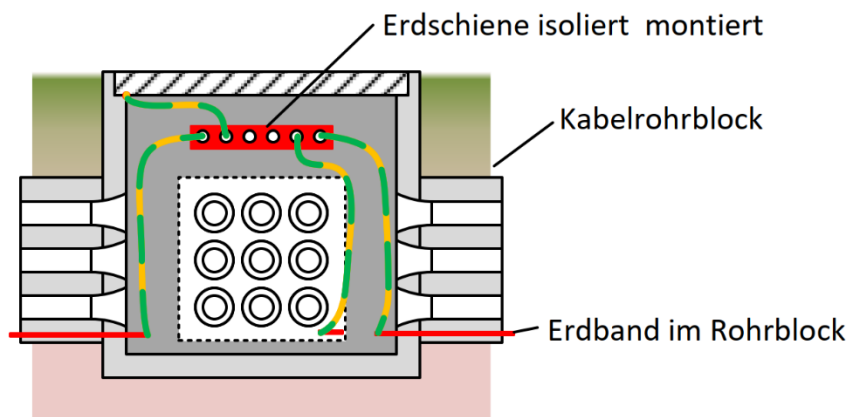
Conduit de câbles de tunnel avec mise à la terre
